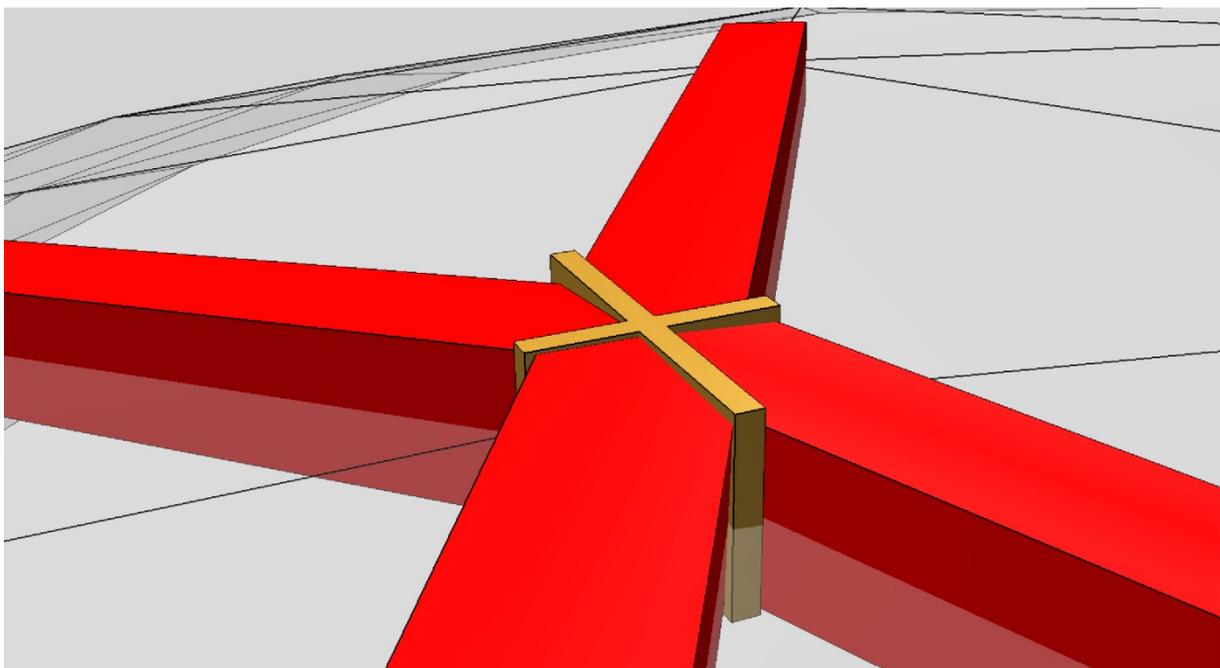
Knotendetail der Gitterschale mit gekreuzten Stahlblechen
